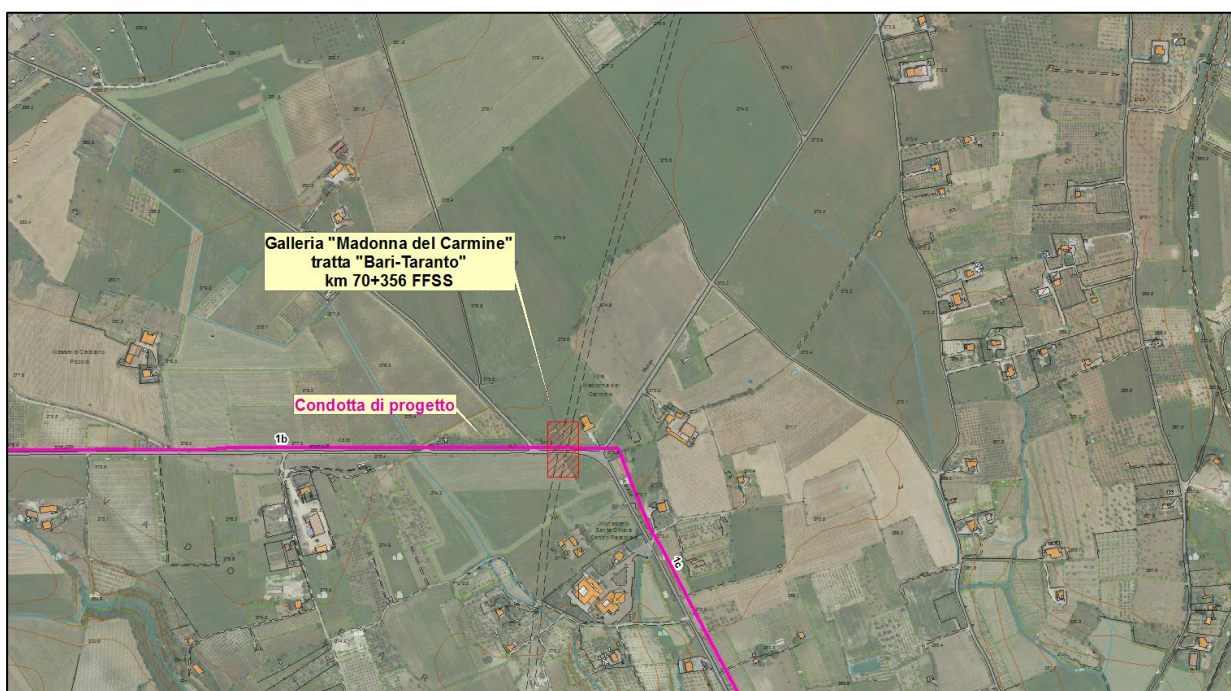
Stralcio planimetrico con individuazione dell'interferenza dell'intervento ID1b con la Galleria "Madonna del Carmine" – tratta Bari – Taranto
